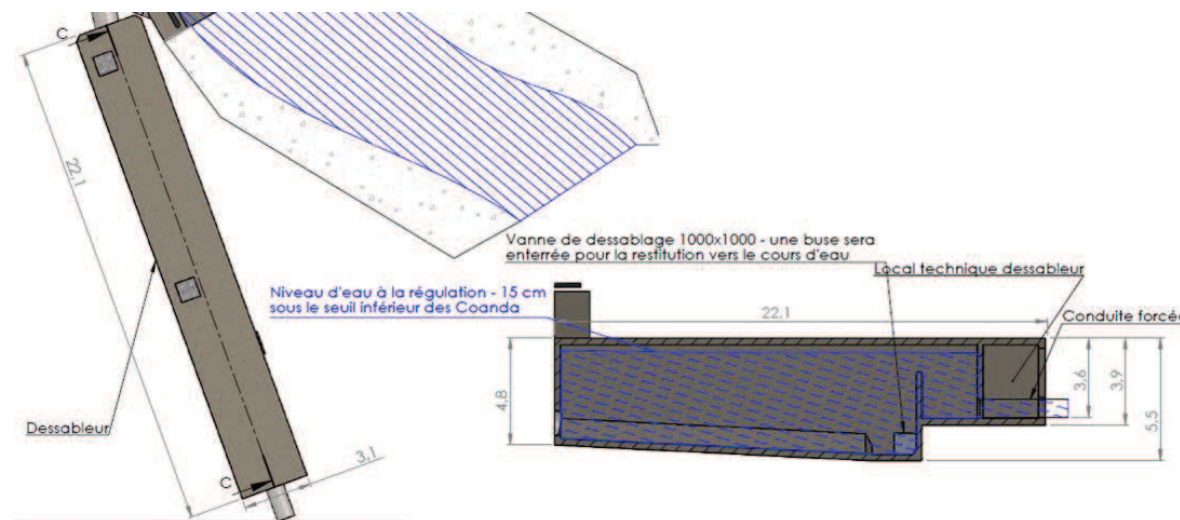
Vue en plan et coupe du dessableur en rive gauche
